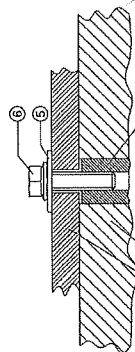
Точки на закрепване на междинни и крайни панели към фундамента
